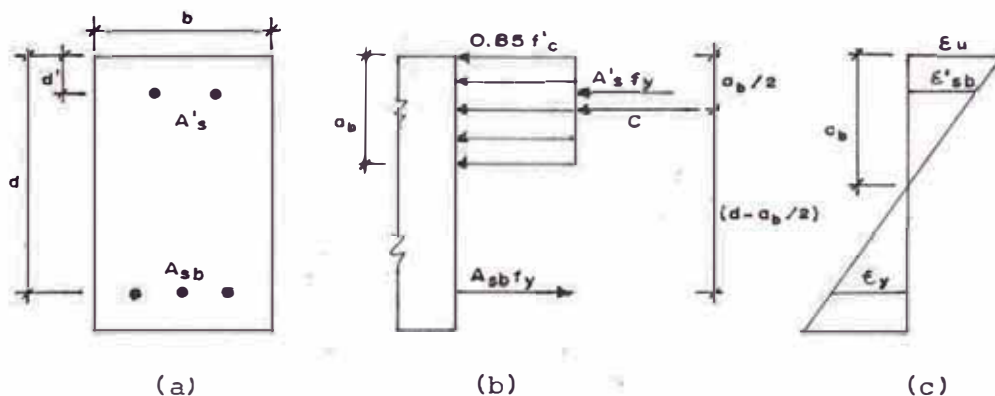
Viga Rectangular Doblemente Reforzada en Estado de Falla Balanceada
